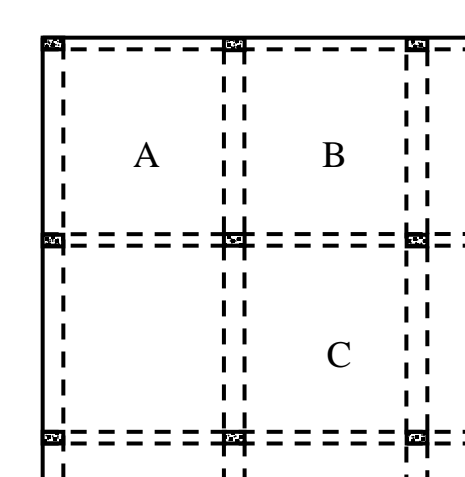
Planta de una losa de piso típica en dos direcciones con vigas en los ejes de columnas.
